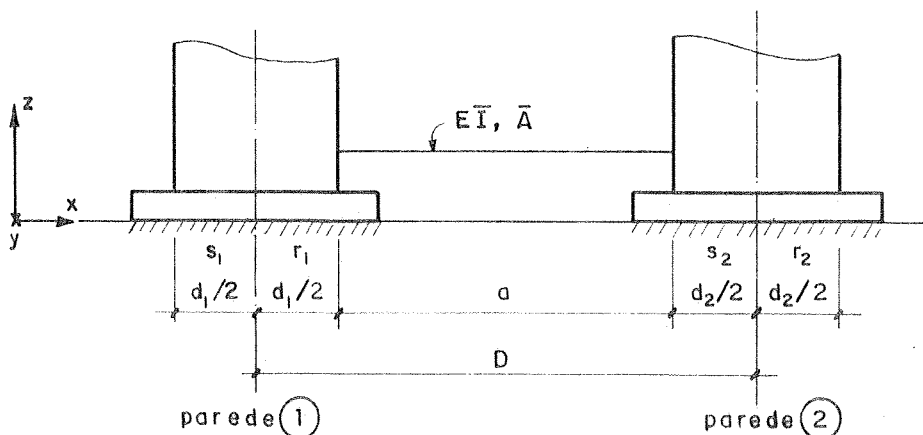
SAPATAS UNIDAS POR VIGA DE RIGIDEZ
